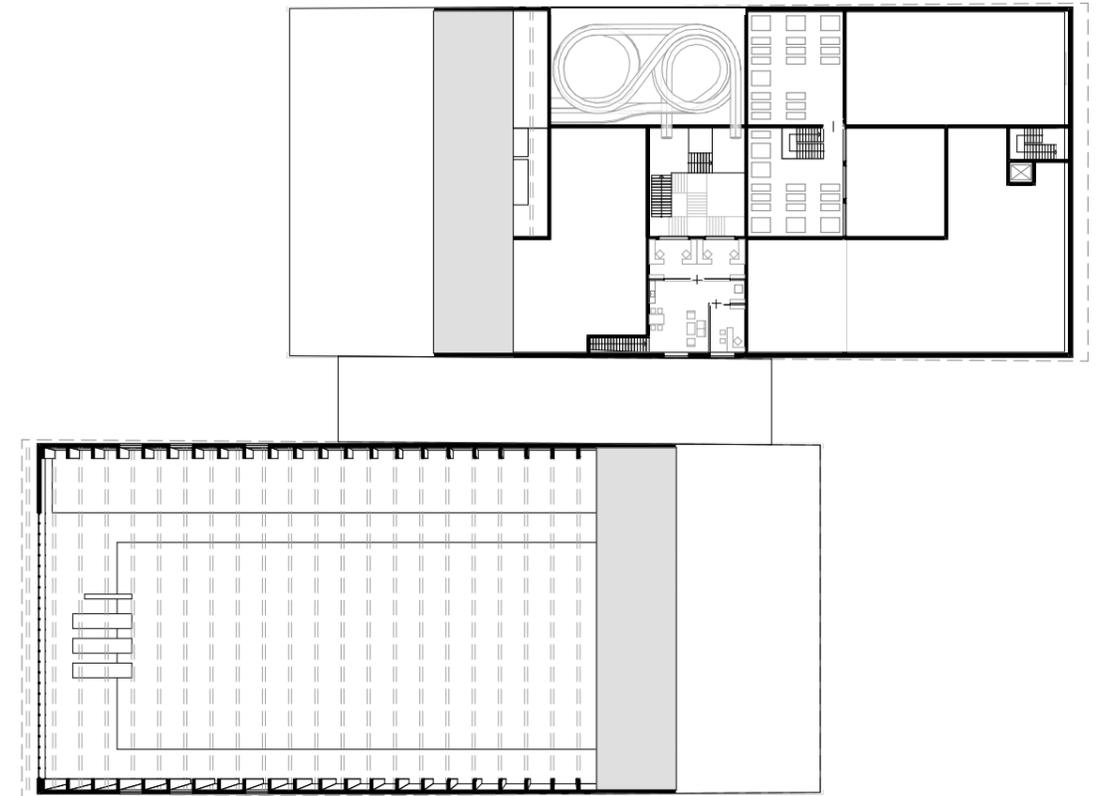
Grundriss 3.Obergeschoss 1:750
